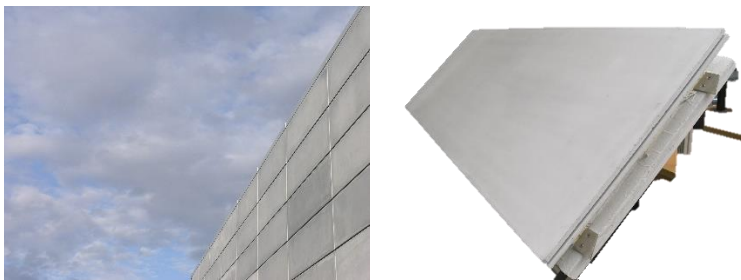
Fassade aus Textilbeton (links); Fassadenelement (rechts)
